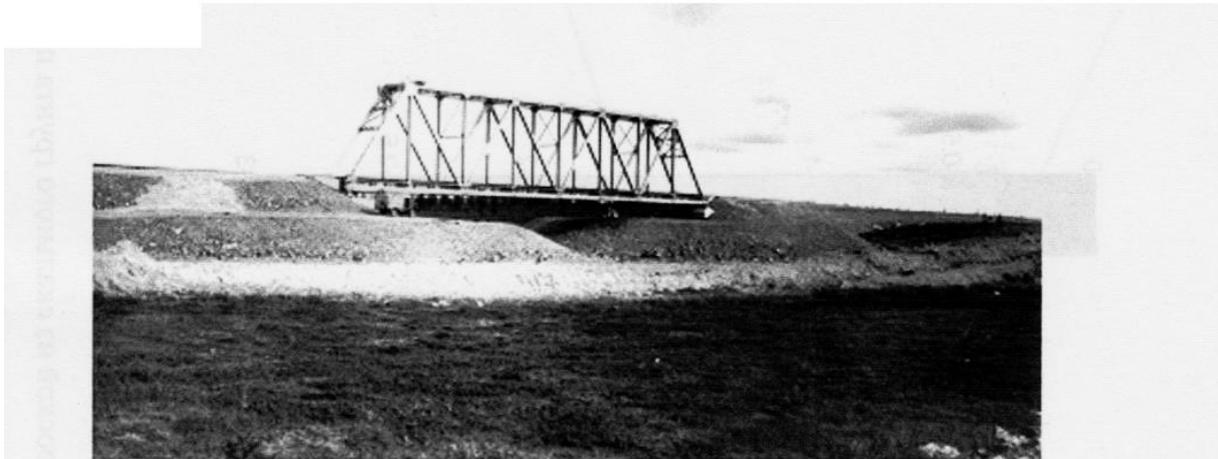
Общий вид моста с уширенными площадками на км 24 железнодорожной линии Обская-Бованенково
